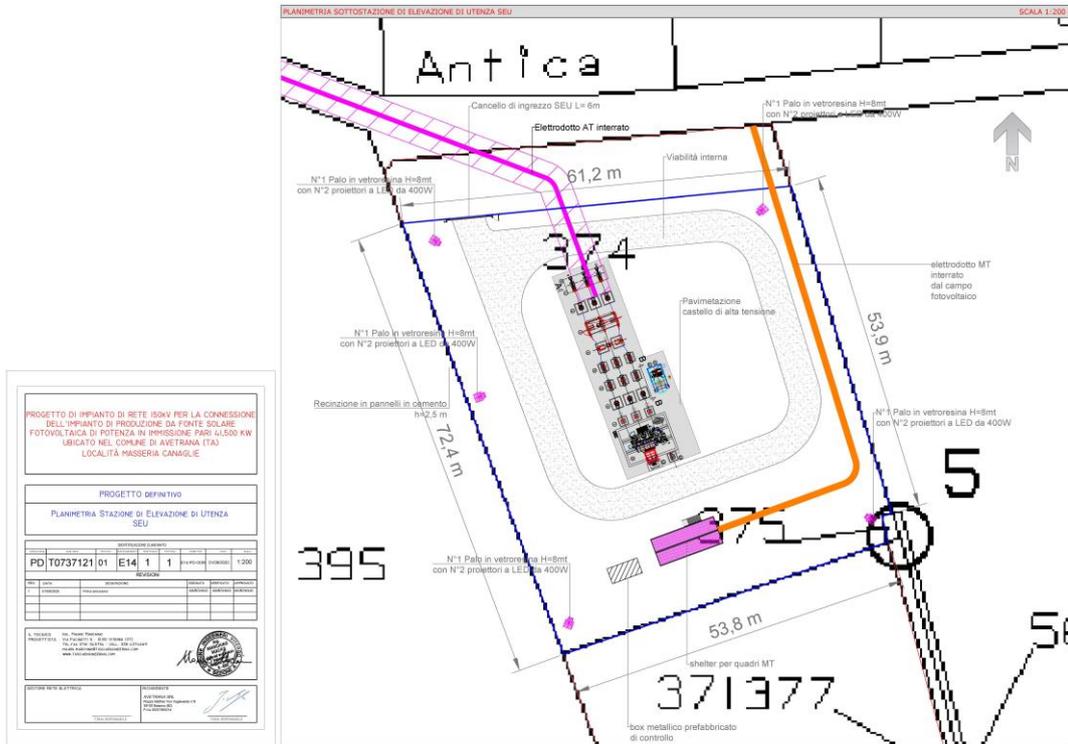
Nuova S.E.U. (Stazione di Elevazione di Utenza) – Schema Planimetrico.
